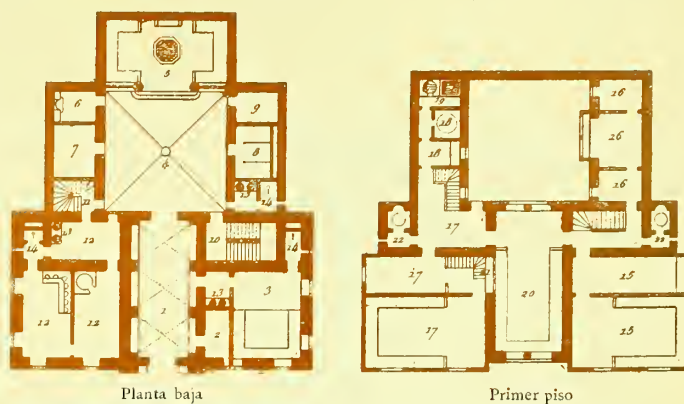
PLANTA DE UNA CASA DE FUAH, EN EL CAIRO
